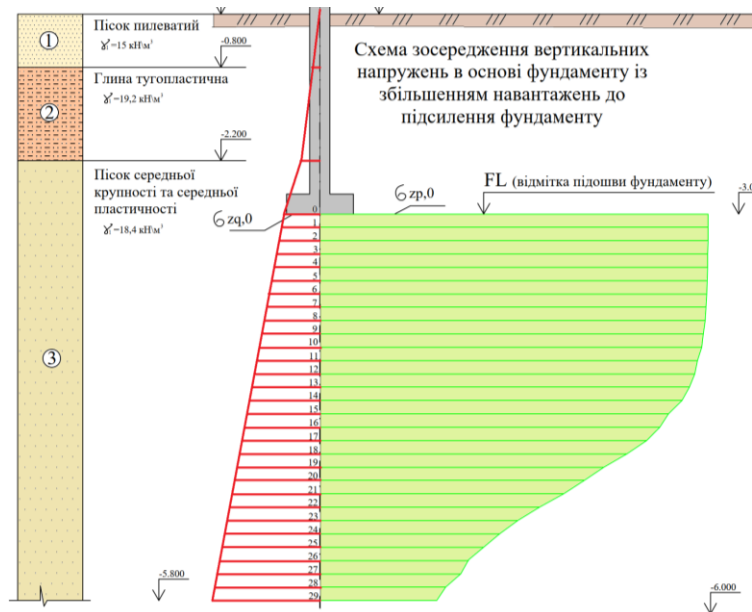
Схема напружень в основі фундаменту до підсилення при збільшені навантаження від реконструкції
